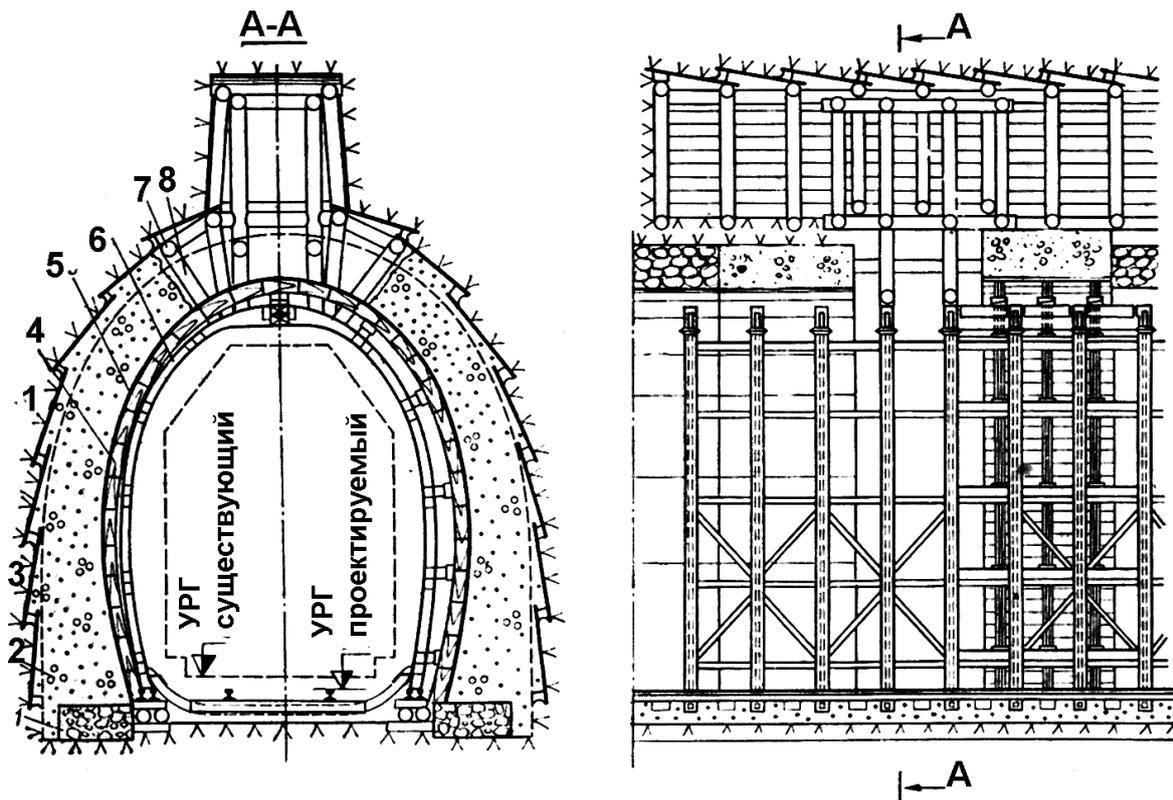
Переустройство свода и стен тоннеля горным способом: 1 – старый фундамент; 2 – новая бетонная обделка; 3 – марчевана; 4 – лекало; 5 – опалубка; 6 – кружало; 7 – лонгарина; 8 – стойка
